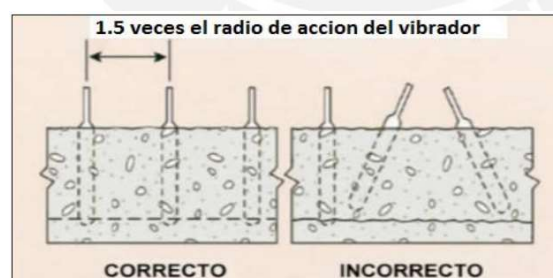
Vibrado de Concreto (ACI 309R-05, 2005)
